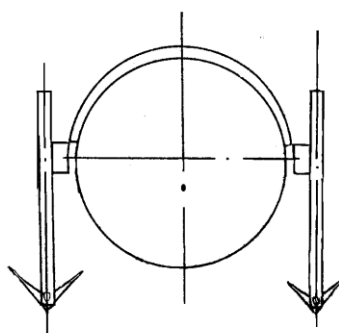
Сварные анкера раскрывающегося типа
